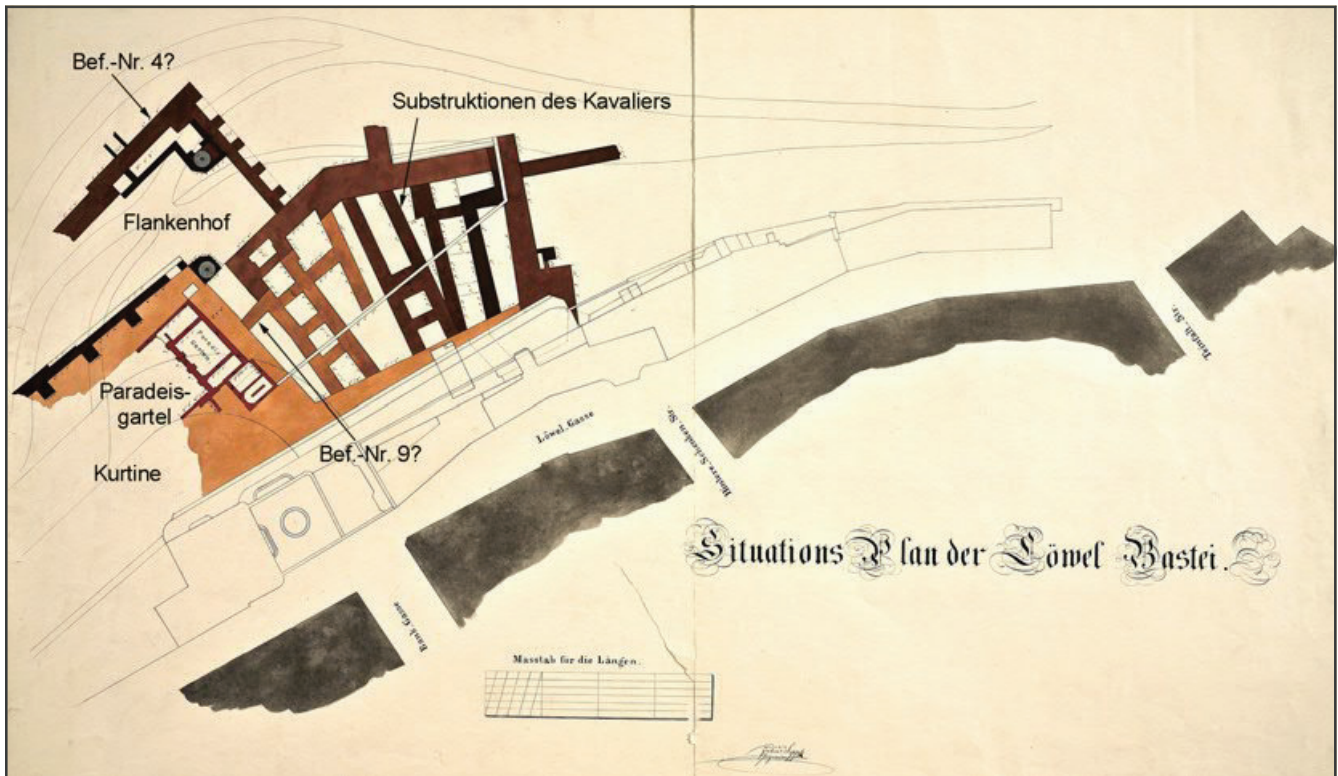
„Situations Plan der Löwel Bastei“, undatiert. Das massive Mauerwerk ist orangefarben dargestellt. (WStLA, KS, Sammelbestand P1 – Pläne und Karten 194G/1)
